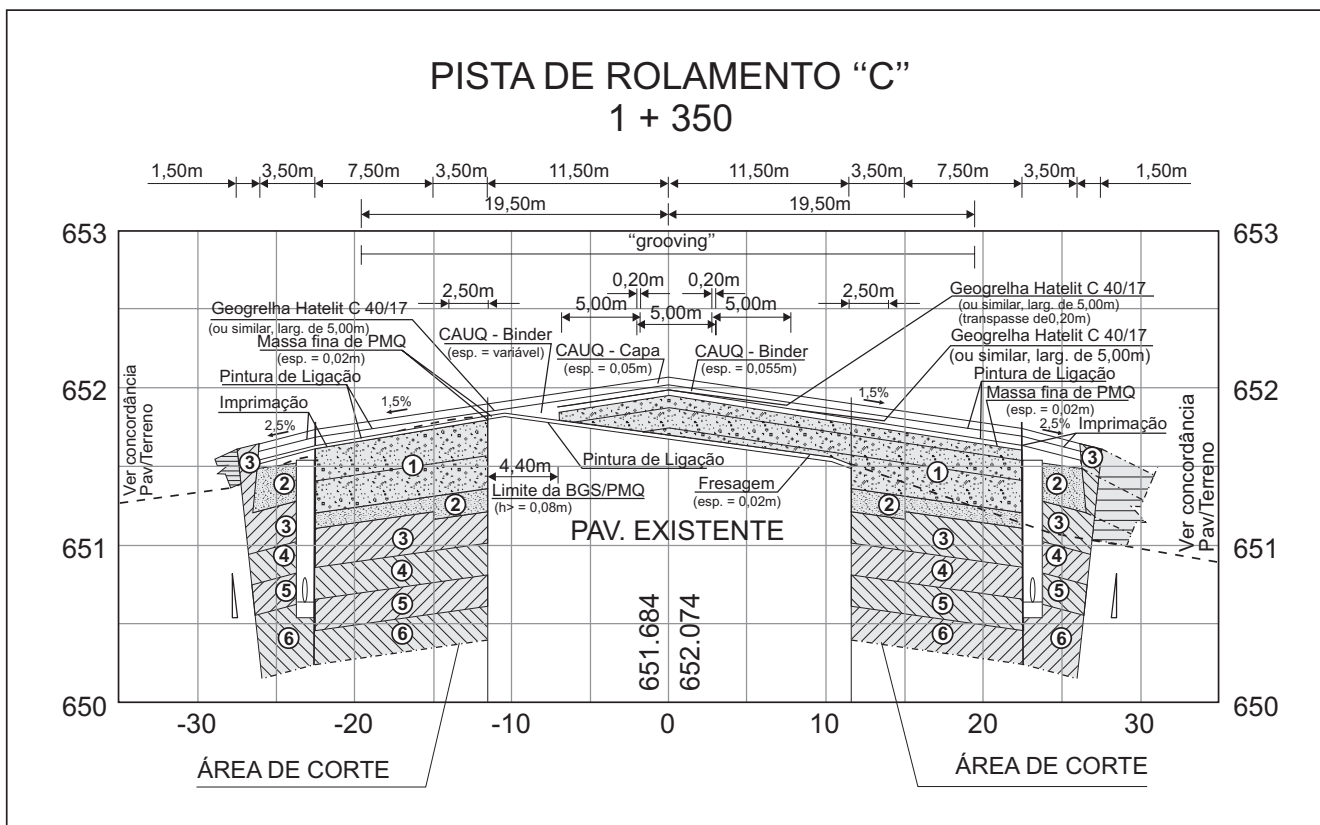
Composição da estrutura do pavimento em trecho de reforço e trecho novo
